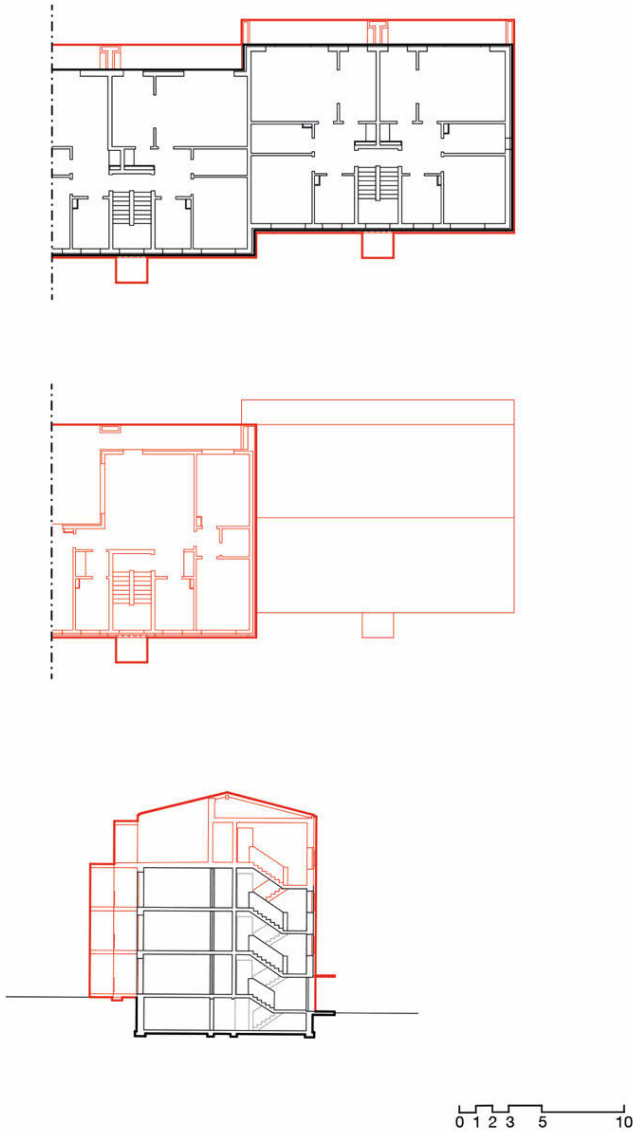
Grundrisse & Schnitt Bestand – Aufstockung 2, Altenhagener Weg
